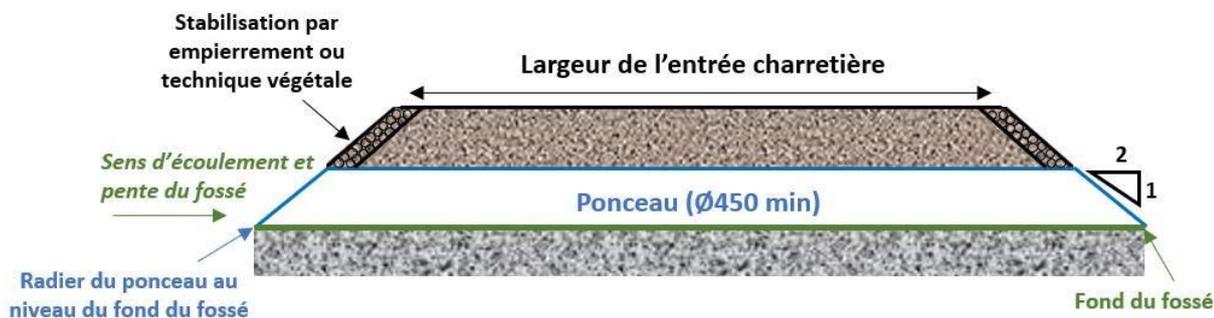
Vue en coupe longitudinale d'un ponceau posé au sein d'un fossé
